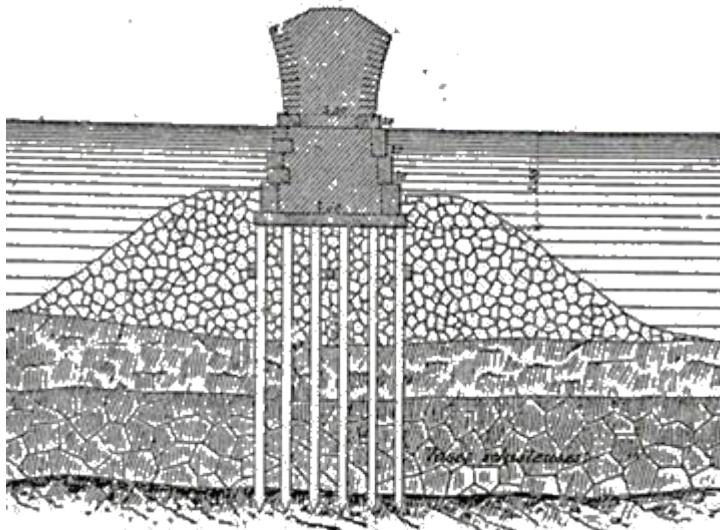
Pont de Bouchemaine sur la Maine. Caisson sur pieux.
